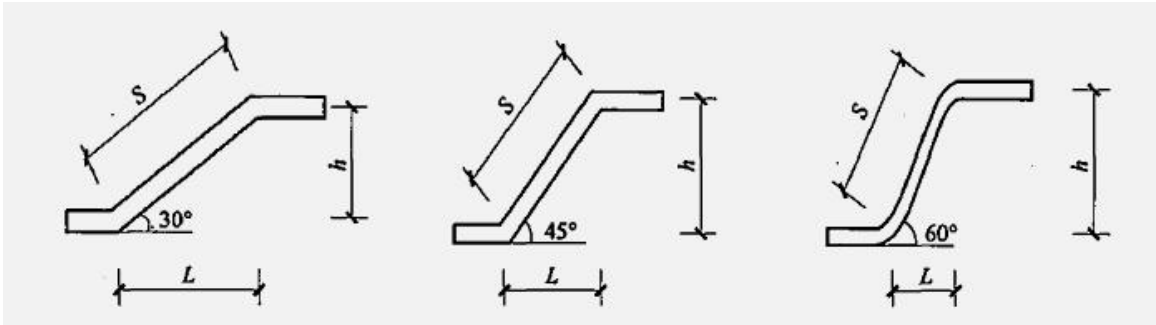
弯起钢筋增加长度示意图 (S-L)
